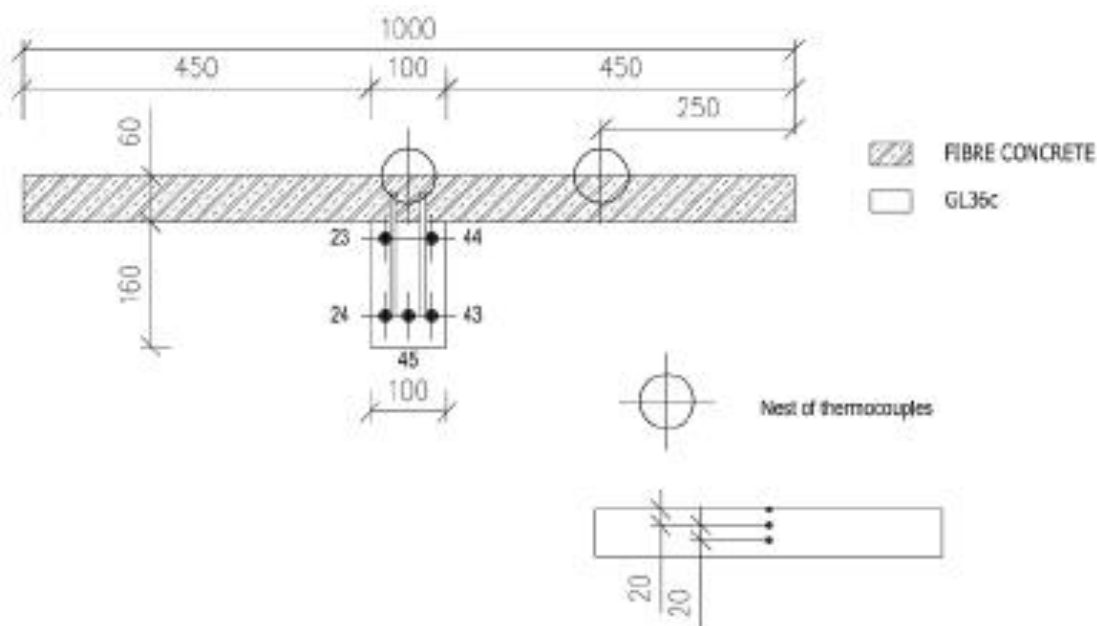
Dřevo-betonová stropní konstrukce vystavená požáru (10)
